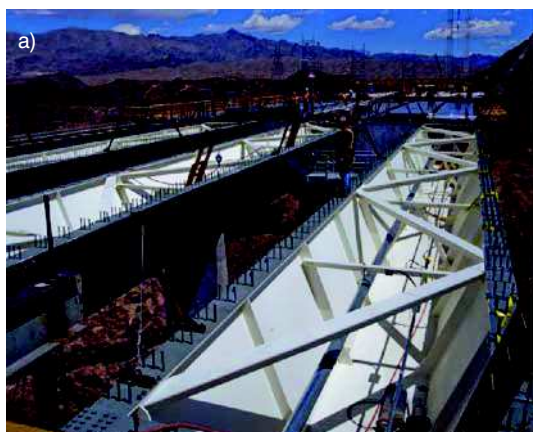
Montaż stalowych elementów skrzynkowych pomostu
